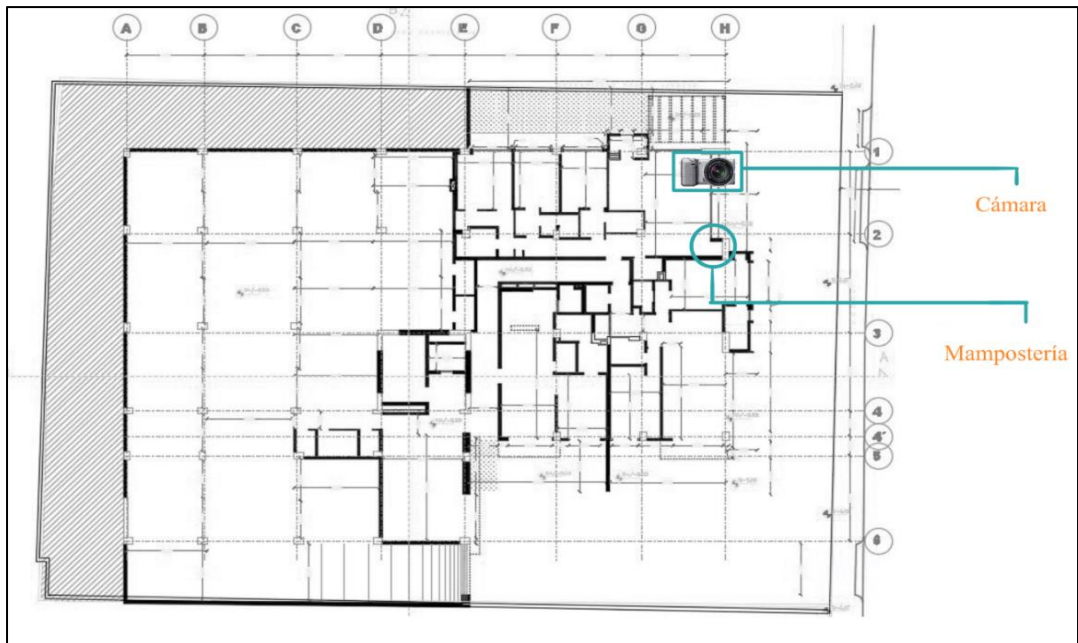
Ubicación cámara y trabajos de mampostería de bloque en el plano
